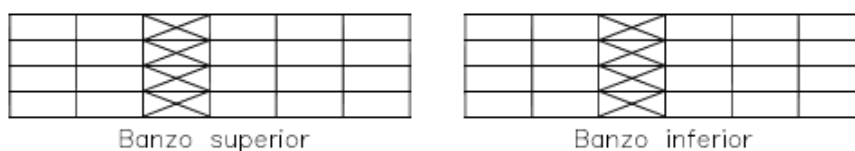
Análise 1: Contraventamento no banzo superior e inferior, no pórtico central
